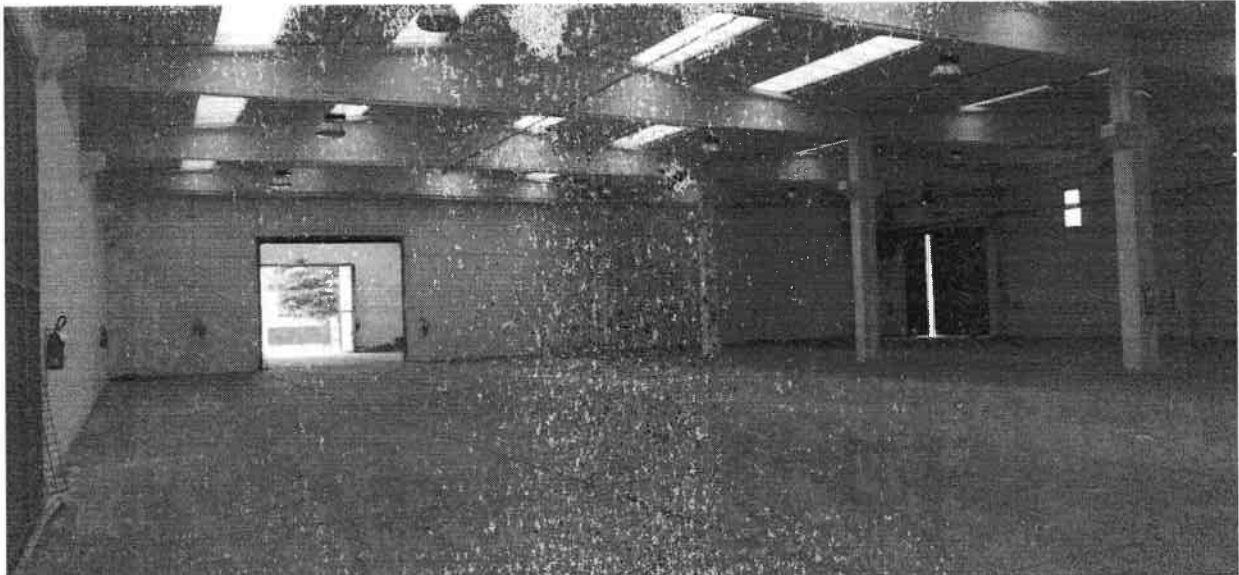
INTERNO CAPANNONE VERSO SUD – PARETE DA DEMOLIRE
